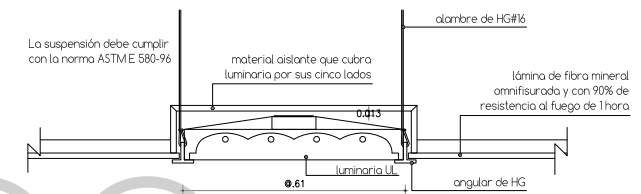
Detalle de luminaria empotrada en gypsum
